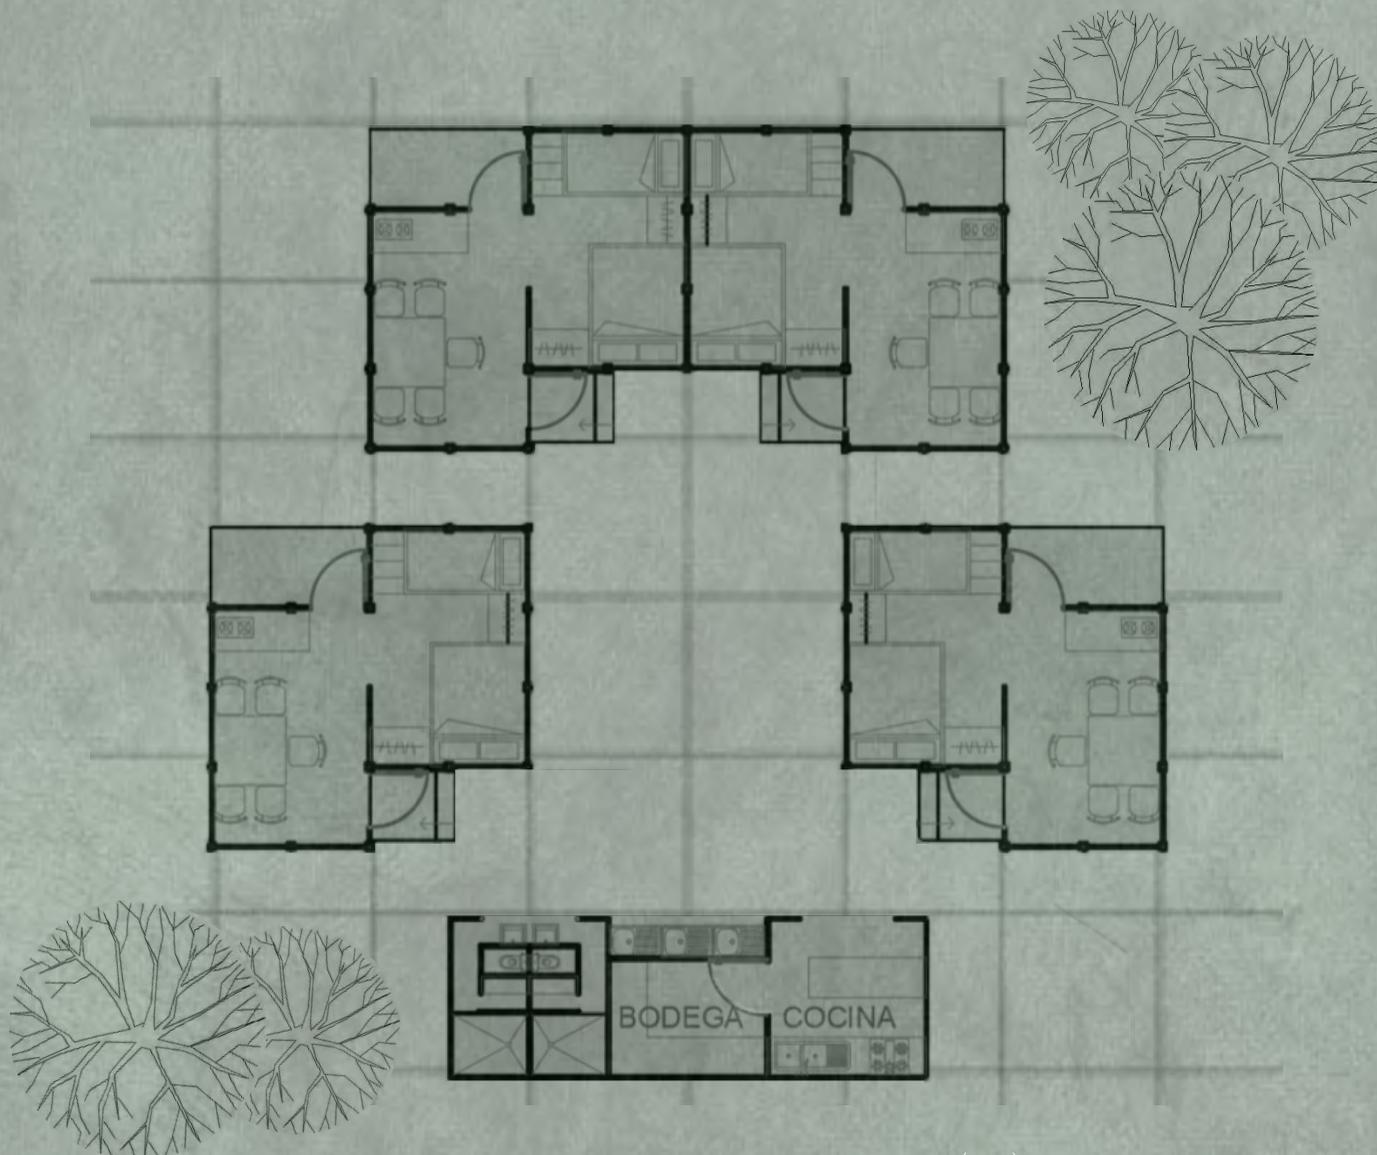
"Conjunto vista en planta". (2018). Elaboración en equipo
